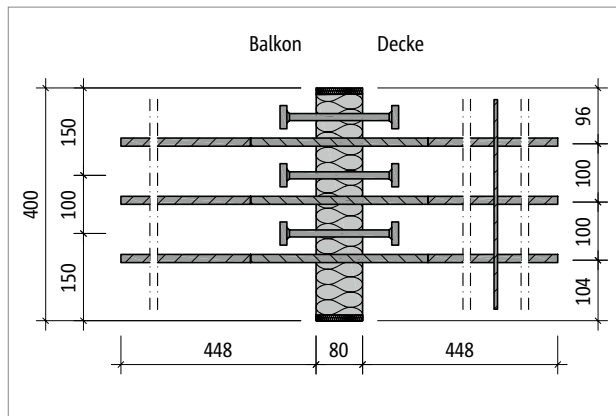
Schöck Isokorb® T Typ QP-V9: Produktgrundriss
